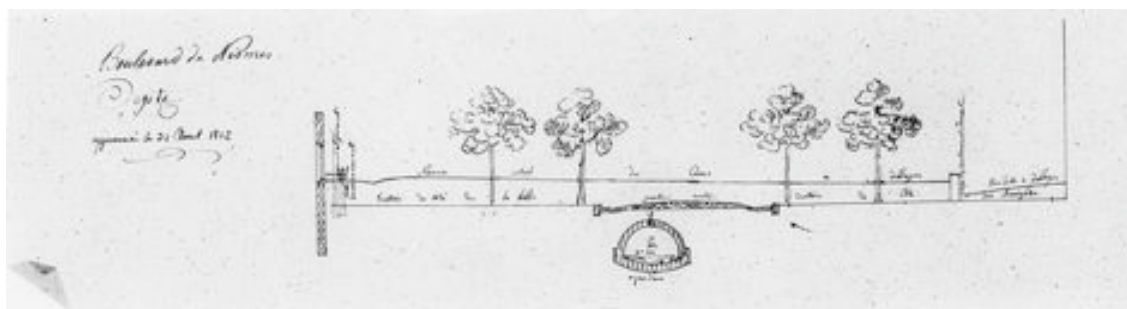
a et b – Détail du plan et de la coupe - (AN)
